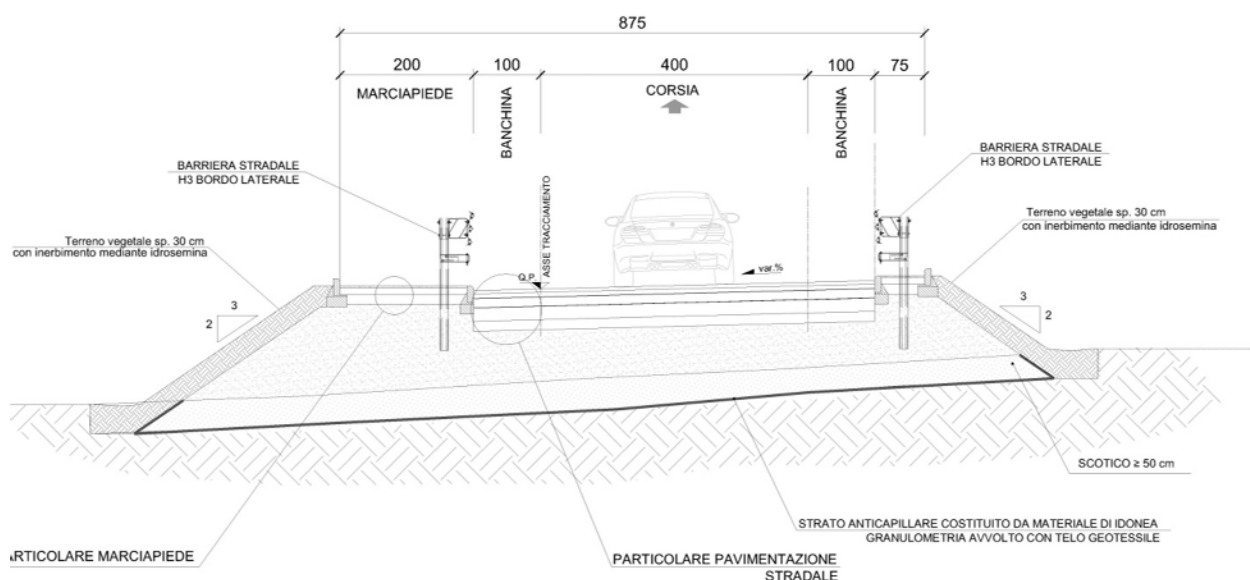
Sezione tipo rampa monodirezionale in rilevato
